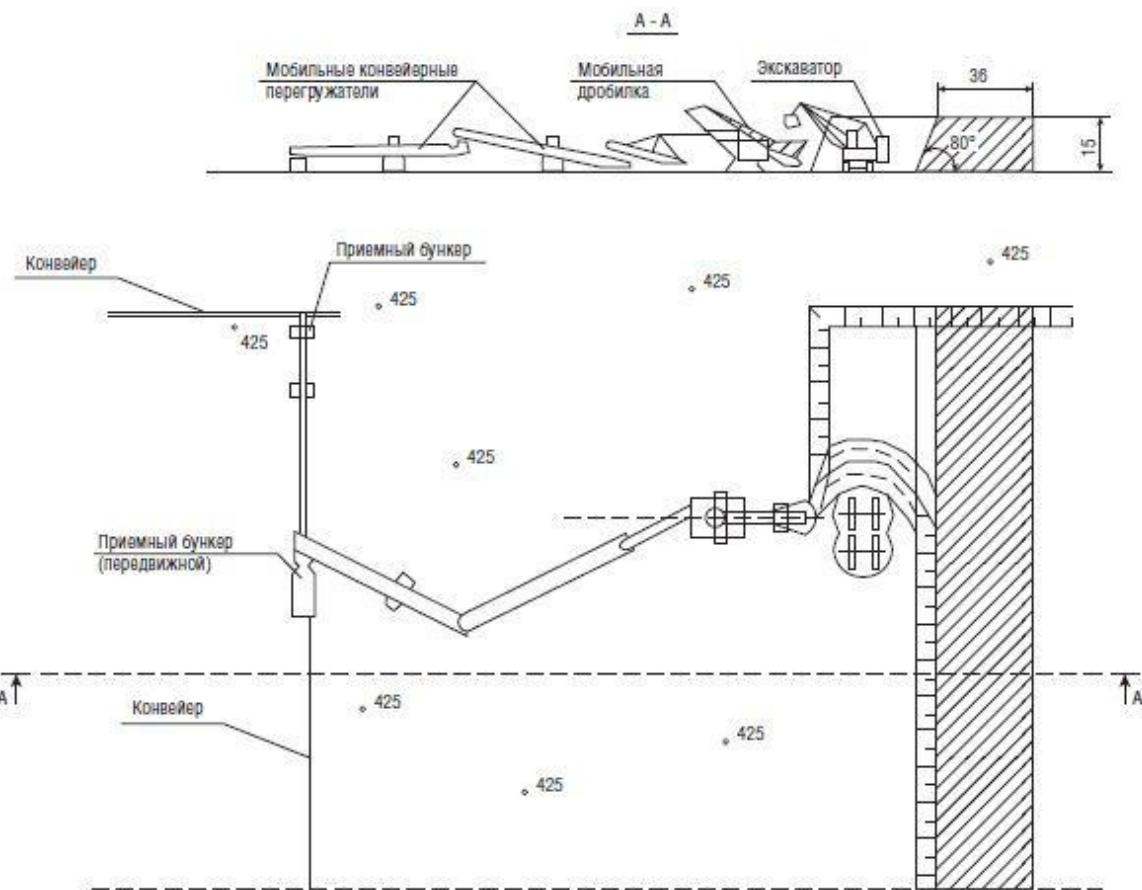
Схема обработки уступа мобильным экскаваторно-дробильным комплексом
